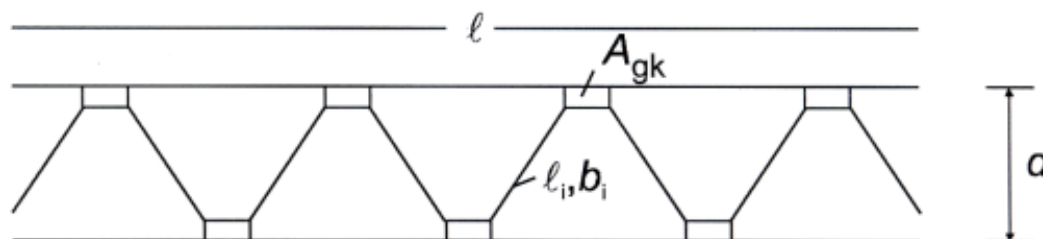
Schema di trave reticolare piana di forma rettangolare.
